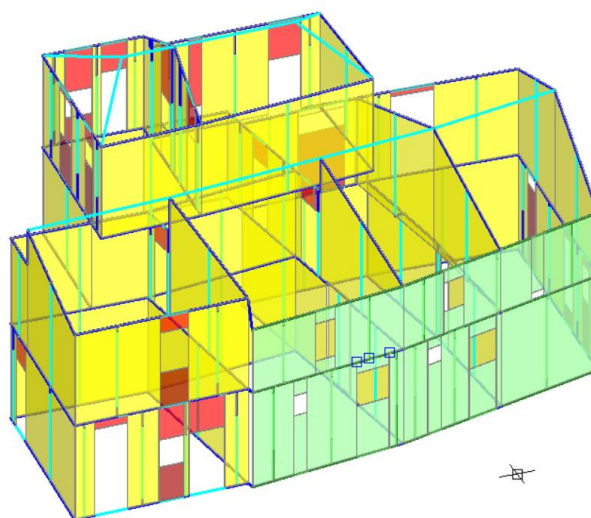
Sottostruttura 1. Selezione elementi del prospetto
